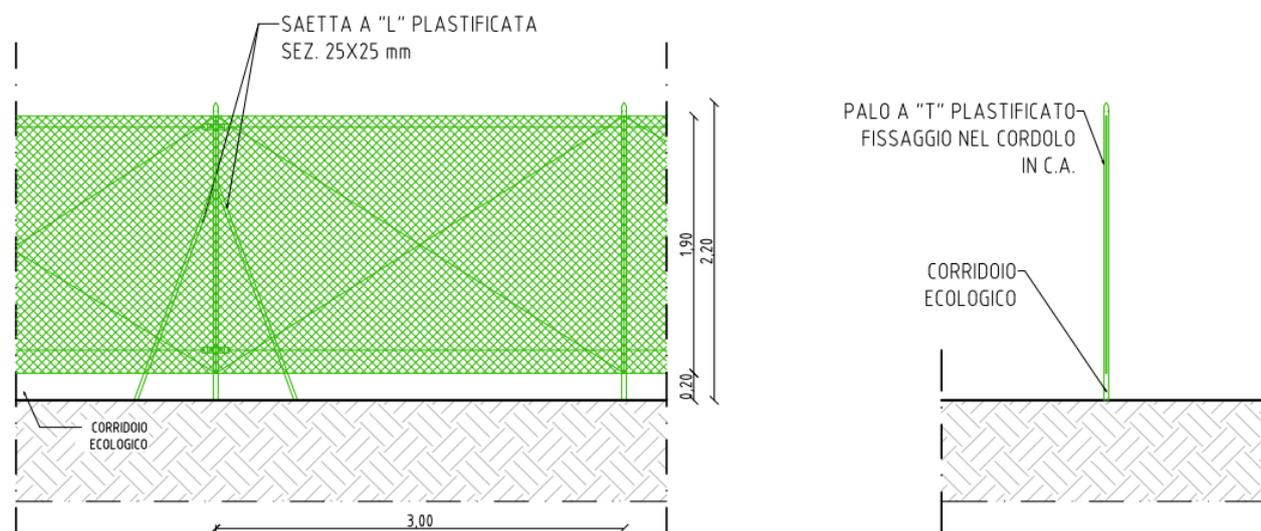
Dettaglio recinzione - Prospetto e sezione
